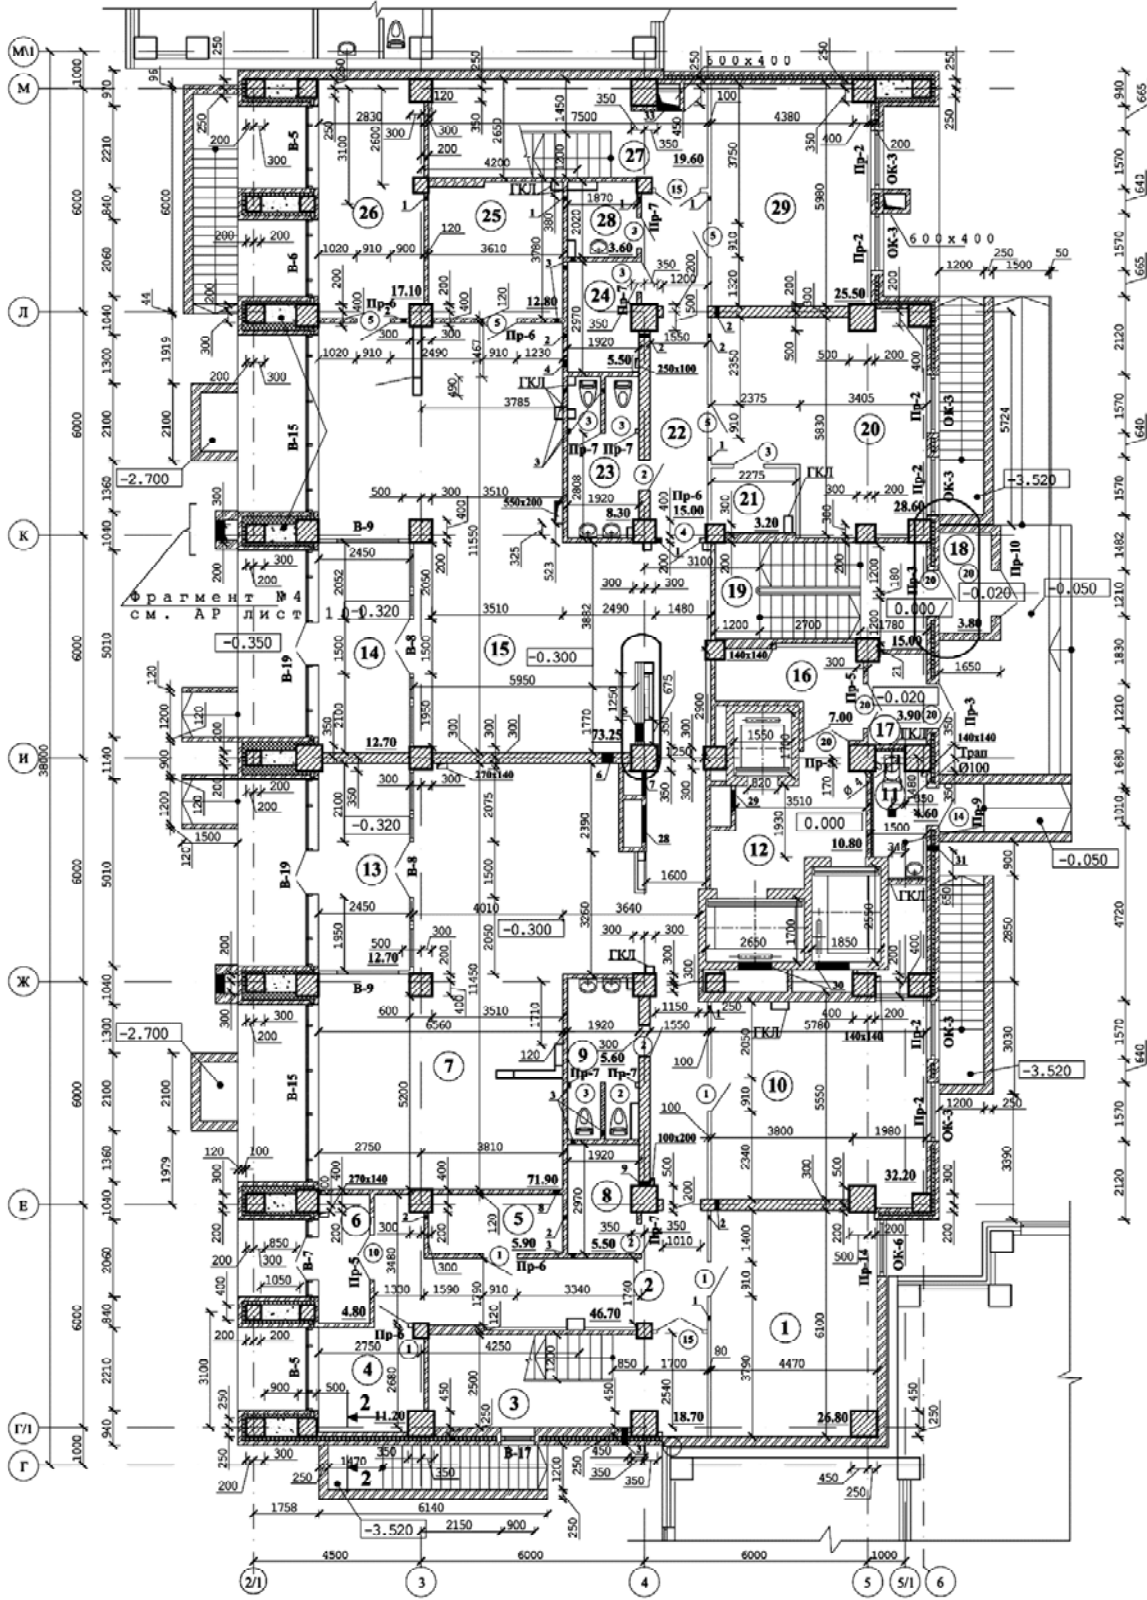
Образец выполнения плана 1-го этажа жилого здания
